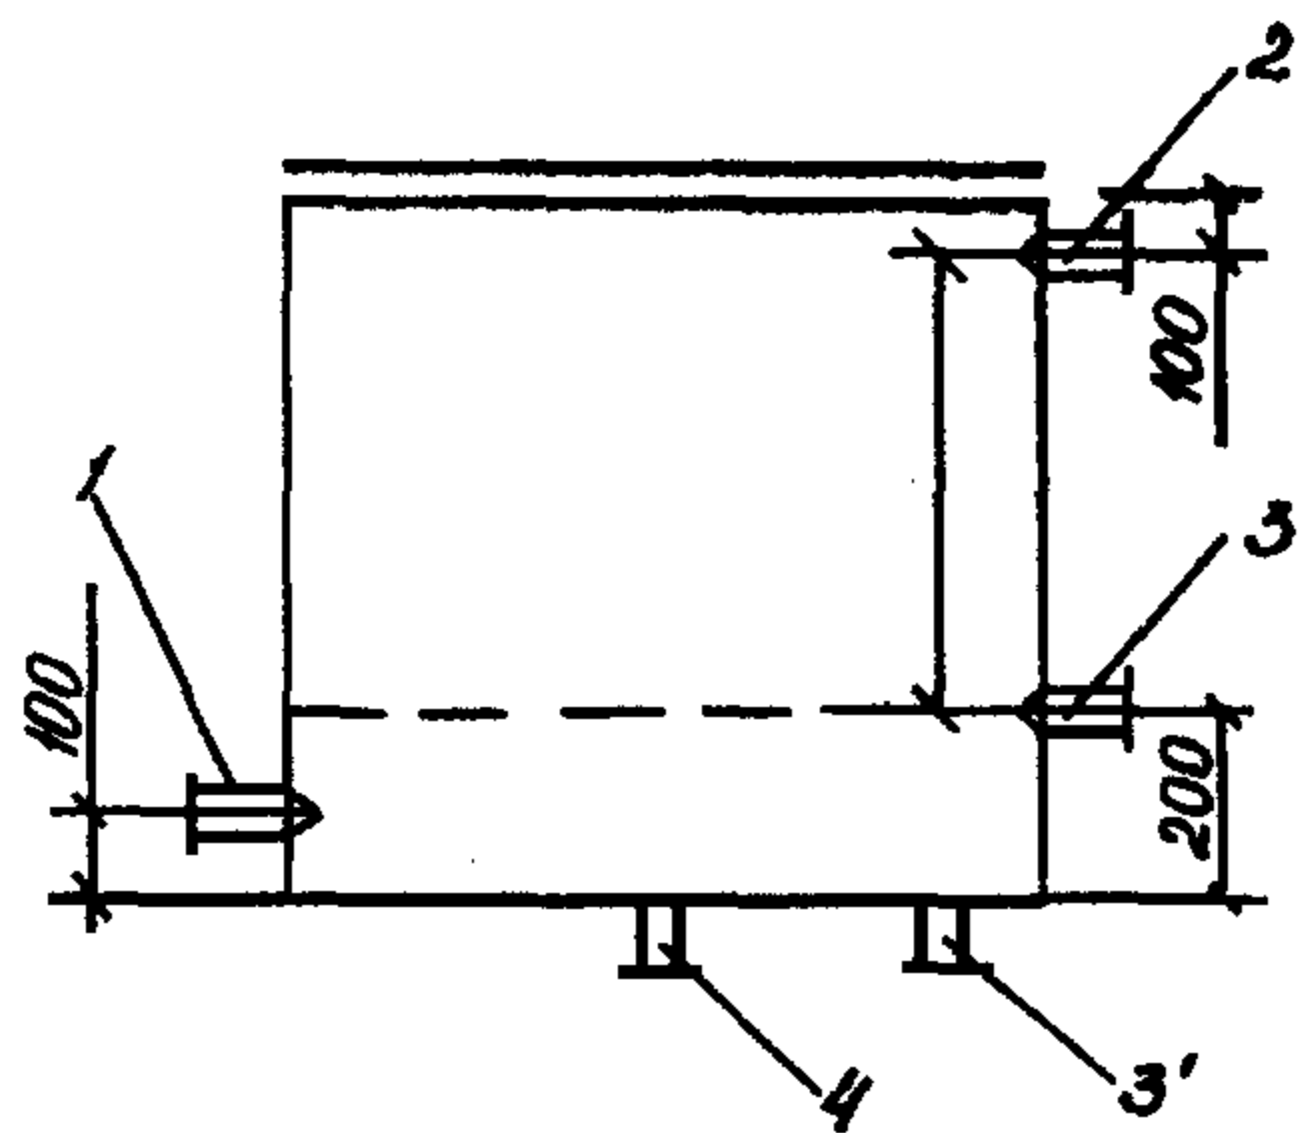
Открытый расширительный бак с патрубками для присоединения труб:
